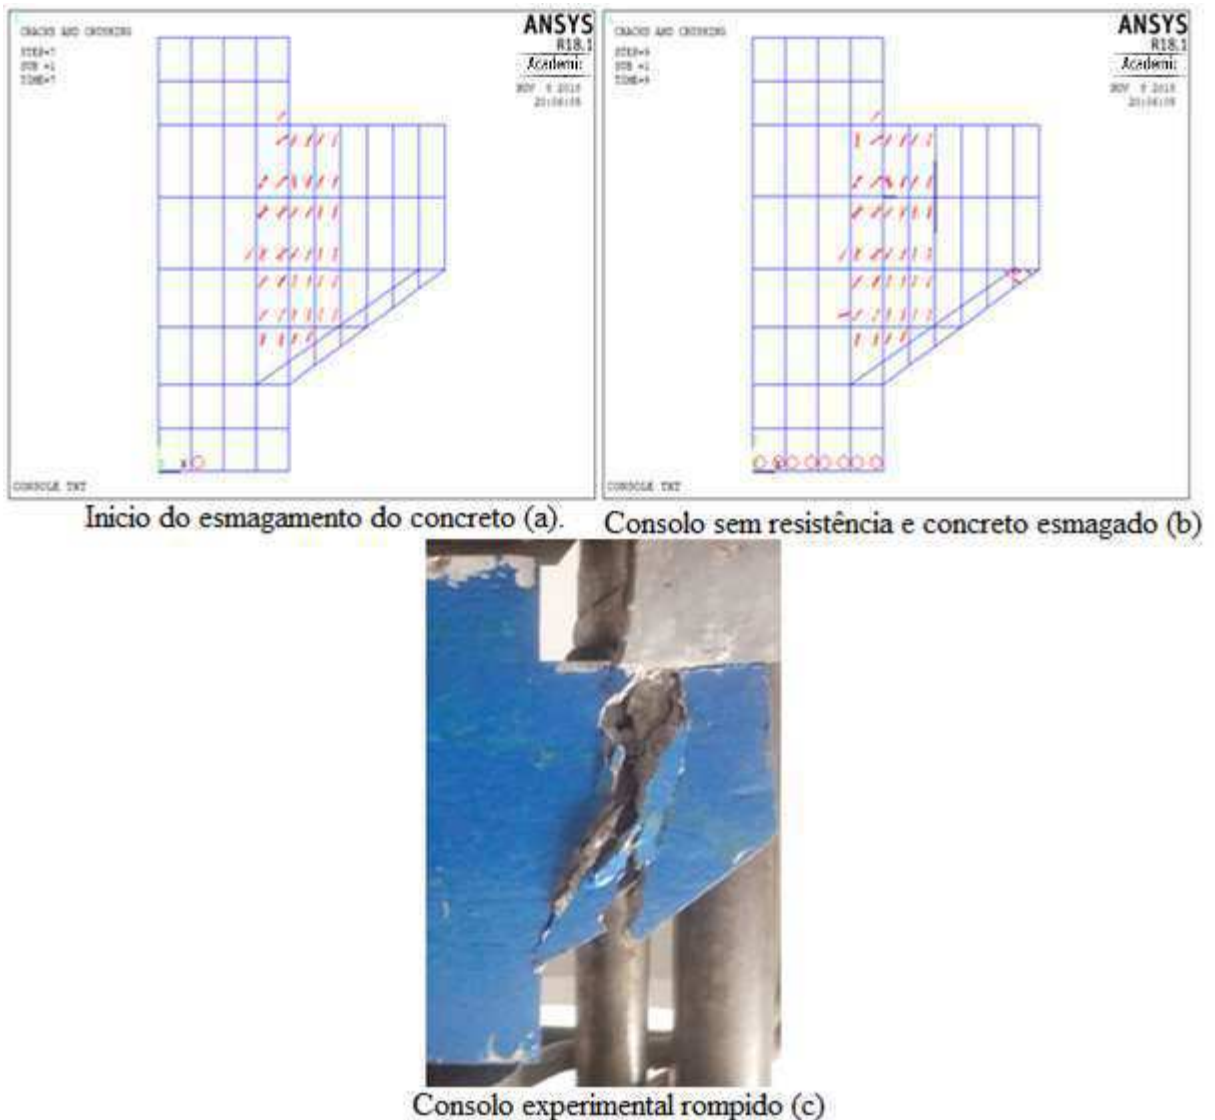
Fissuras no modelo com aplicação da carga de rompimento segundo a ABNT NBR 9062:2006.
